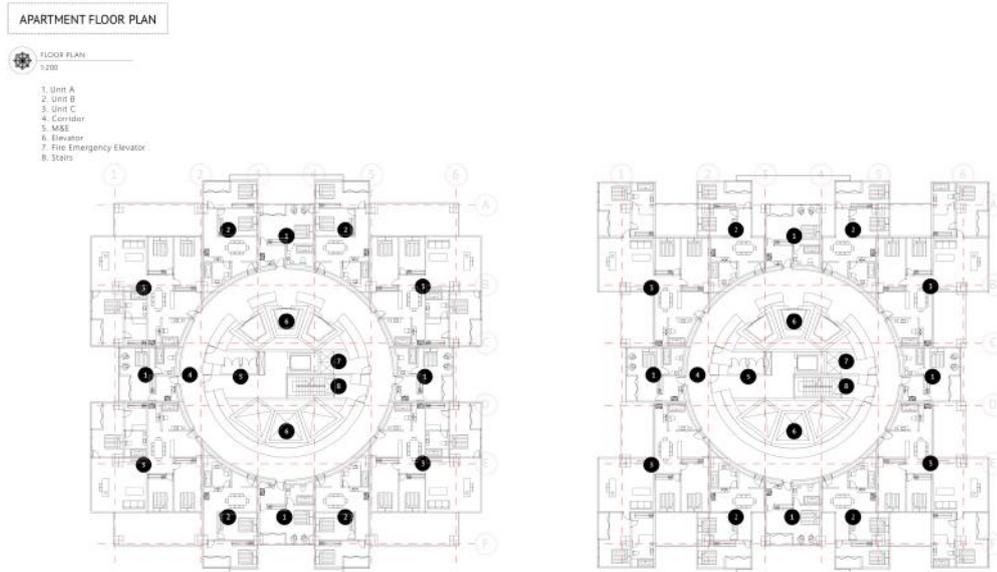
Denah Lantai 3. Sumber: Dok.Prbadi
